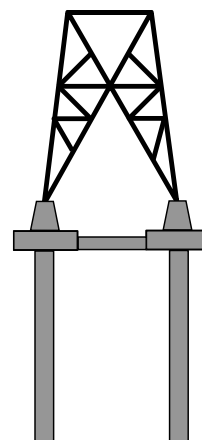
Cimentación profunda a base de pilas en una torre de transmisión eléctrica tipo.
